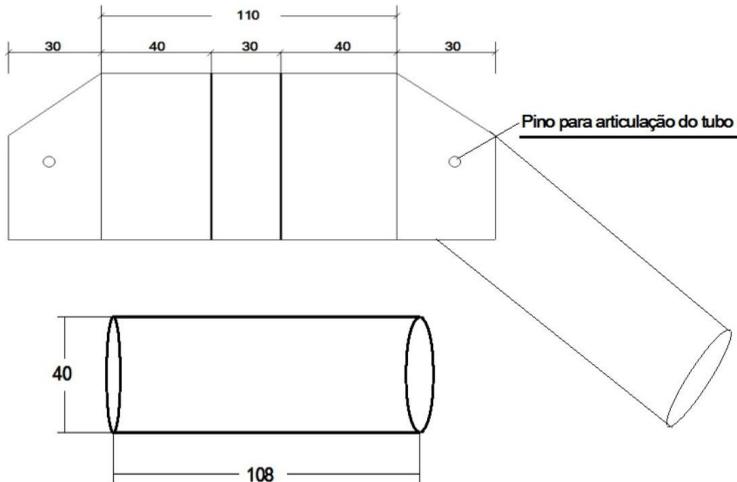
Peça metálica para estruturação da cobertura, faz a ligação com as peças de bambu. No detalhe acima, tubo de ligação entre o anel e os colmos de bambu (medidas em milímetros).
